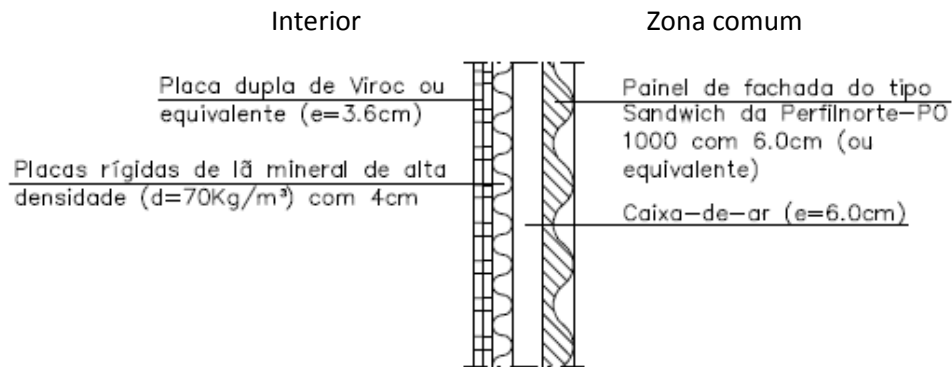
Pormenor construtivo da parede Pi3 [19]
